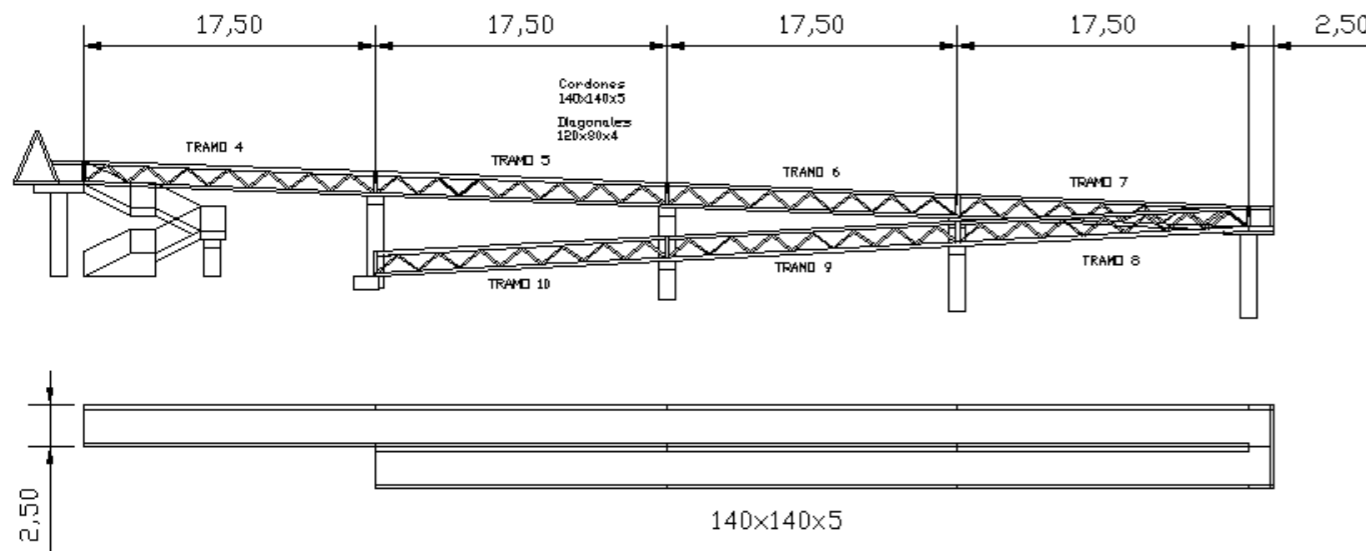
Alzado y planta superior de los tramos 4 al 10.
